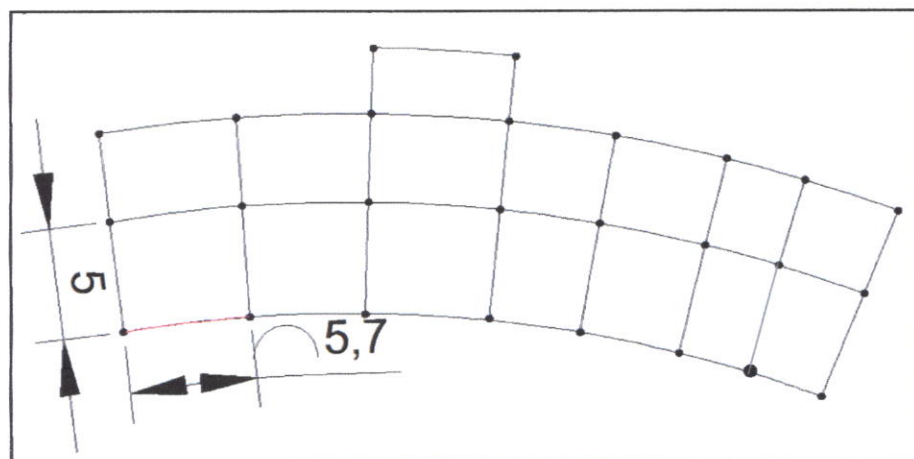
Plan de structure pour les bungalows (Source: l'auteurs)
